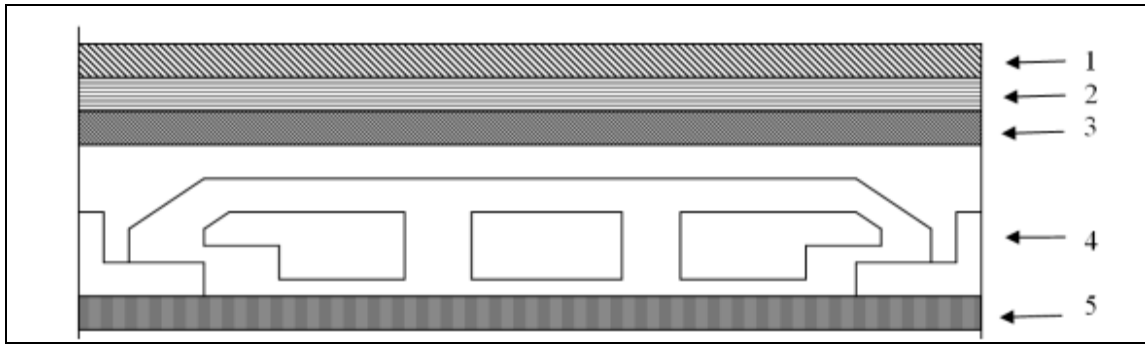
Descente de charge de Plancher terrasse inaccessible
